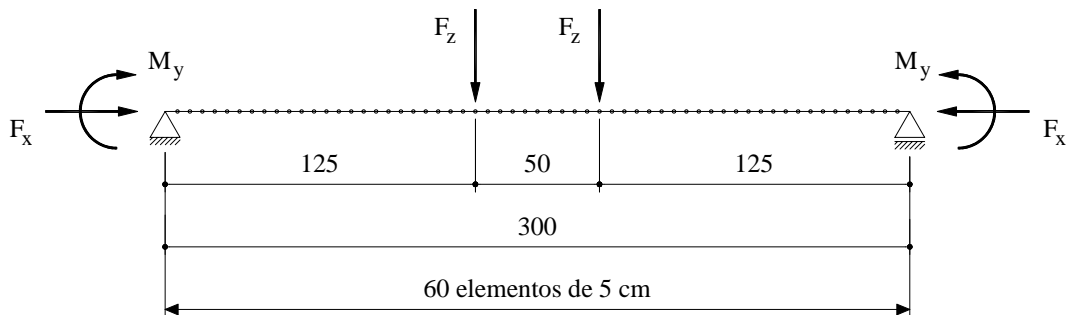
Discretização longitudinal (dimensões em cm)
